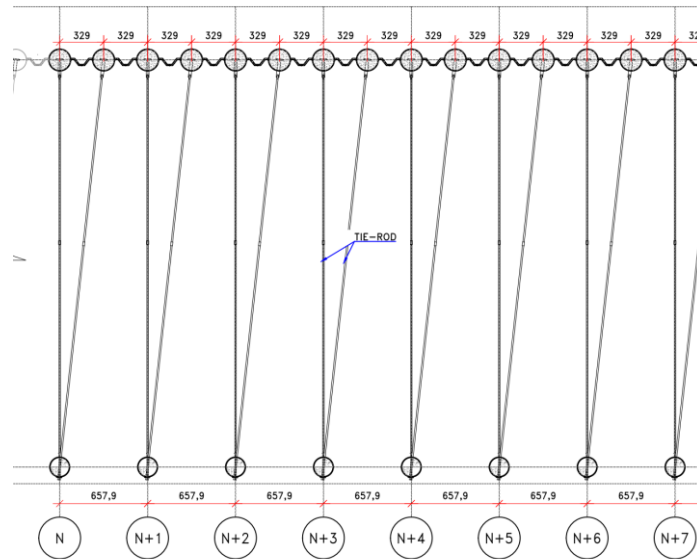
Vista en planta del arriostrado del combi-wall.
